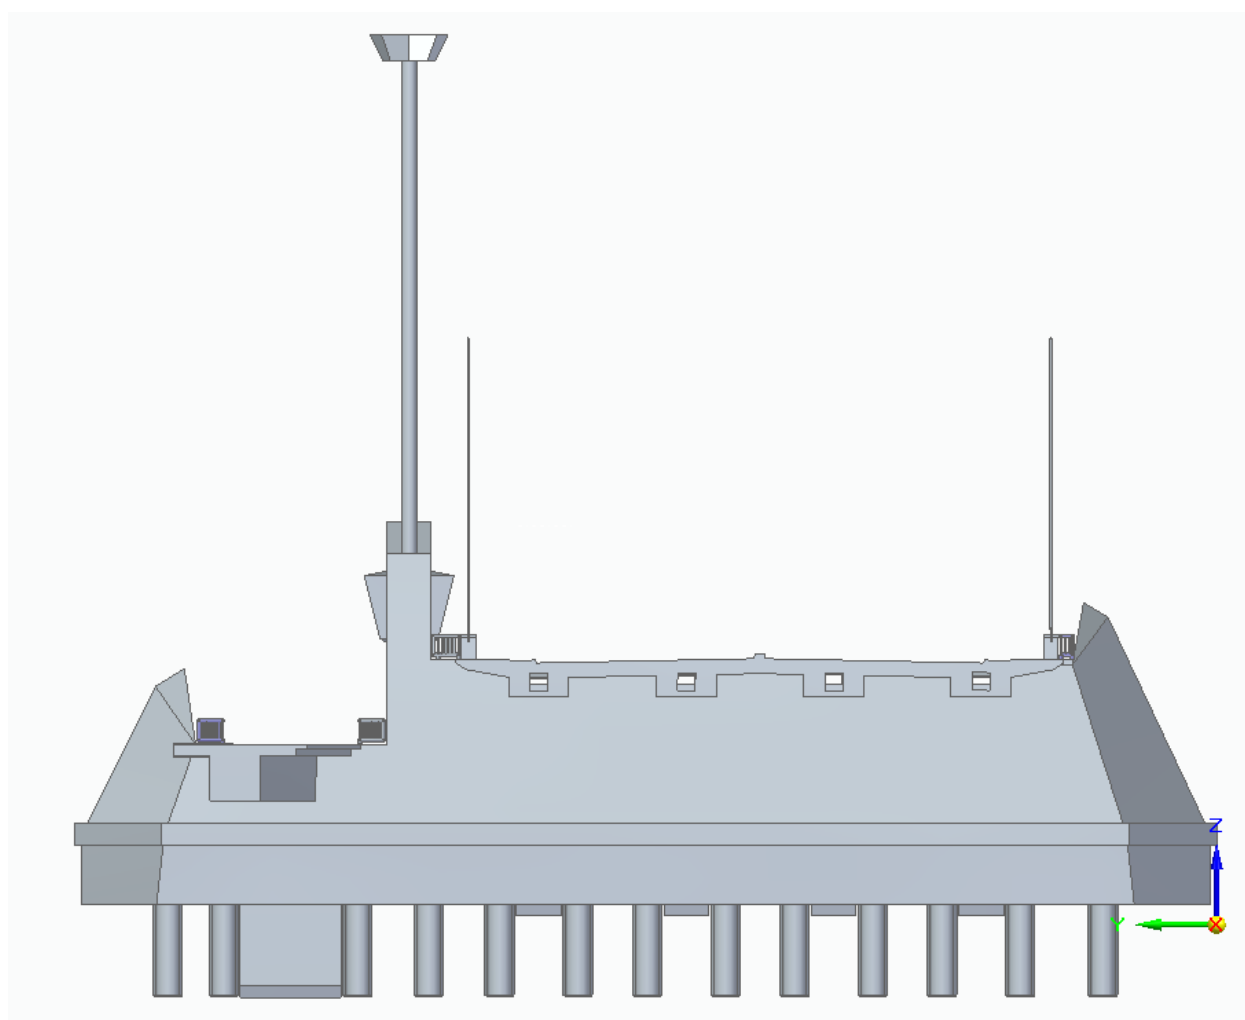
Perfil pila 1 puente de Las Delicias.
